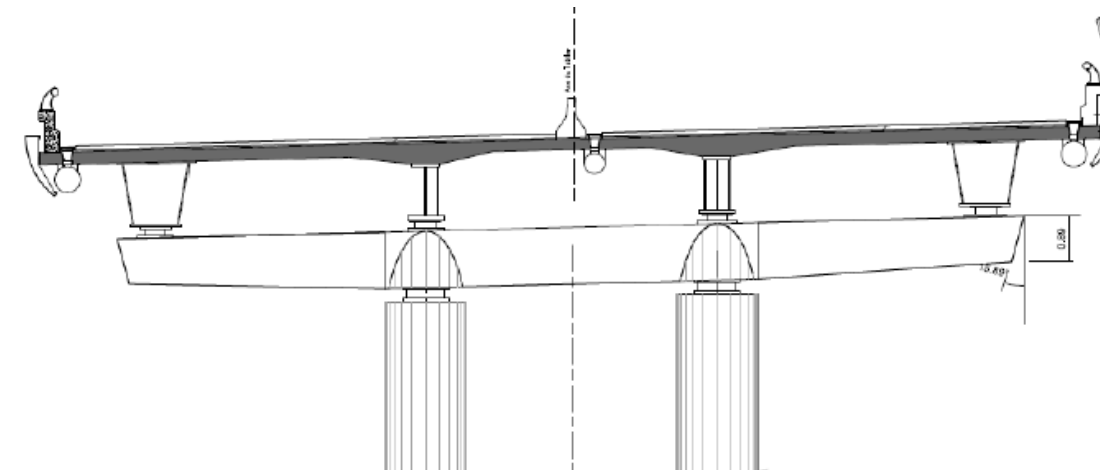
Coupe du pont élargi au niveau des pilettes (source CEREMA)
